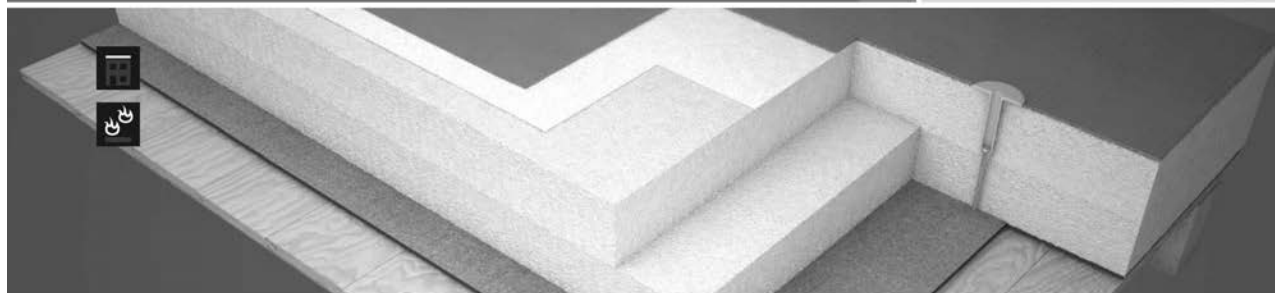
Detail střešního vtoku (skladba DEKROOF 06)
